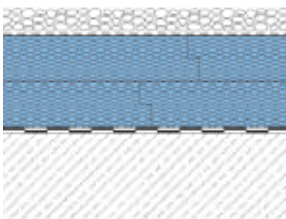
Zweilagige Verlegung im Umkehrdach mit ROOFMATE™ erfüllt die Passivhausanforderung
